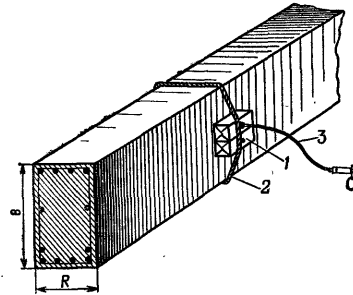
Подрывание железобетонной балки наружным сосредоточенным зарядом: 1 — заряд; 2 — веревка (провода); 3 — зажигательная трубка
